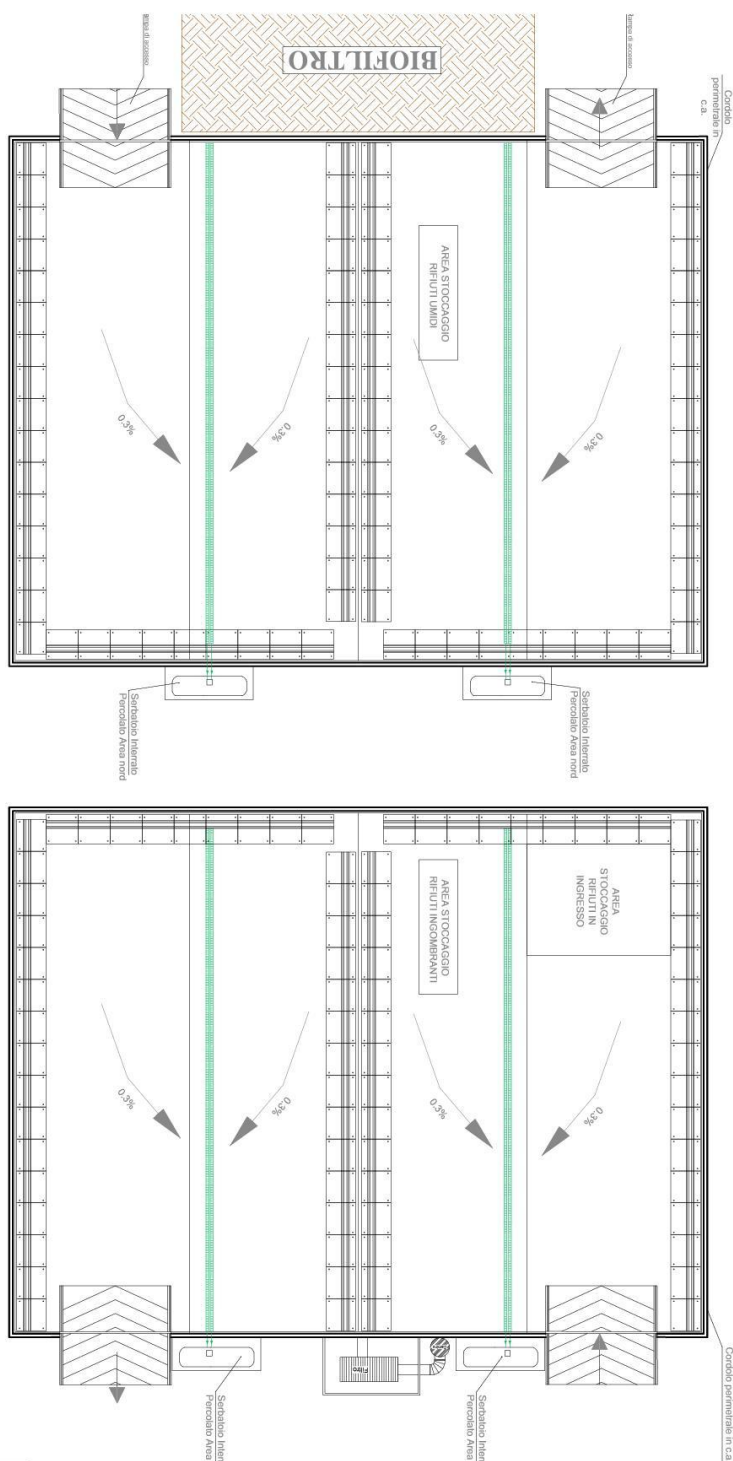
Estratto Planimetria Sistema di Raccolta Percolato.
